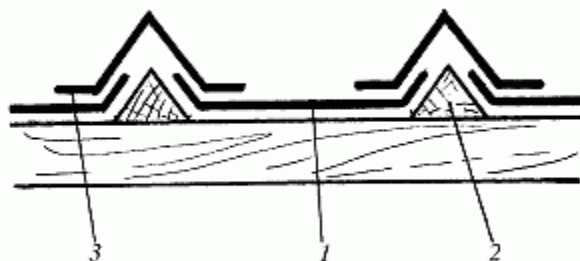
Устройство кровли с использованием треугольных брусков: 1 – рулонный материал; 2 – треугольный брусок; 3 – насадка из рубероида или толя
